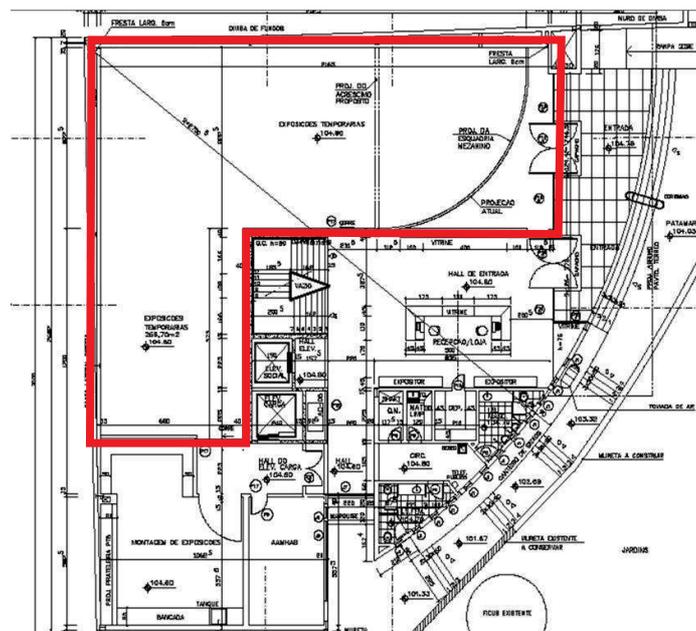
Planta 1º Pavimento do Anexo do Museu Abílio Barreto – sala de exposições temporárias. Fonte: Acervo do Museu Abílio Barreto
